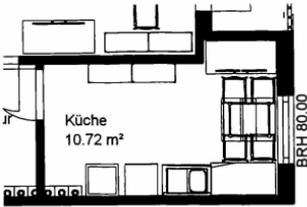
Grundriss der Küche im Oberhaus
